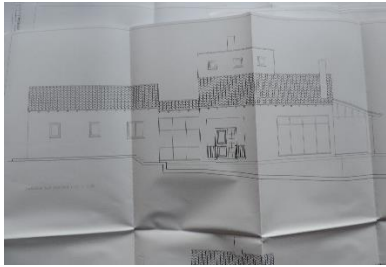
Extracto del plano de arquitectónico Fachada principal. Fuente propia. 2018
